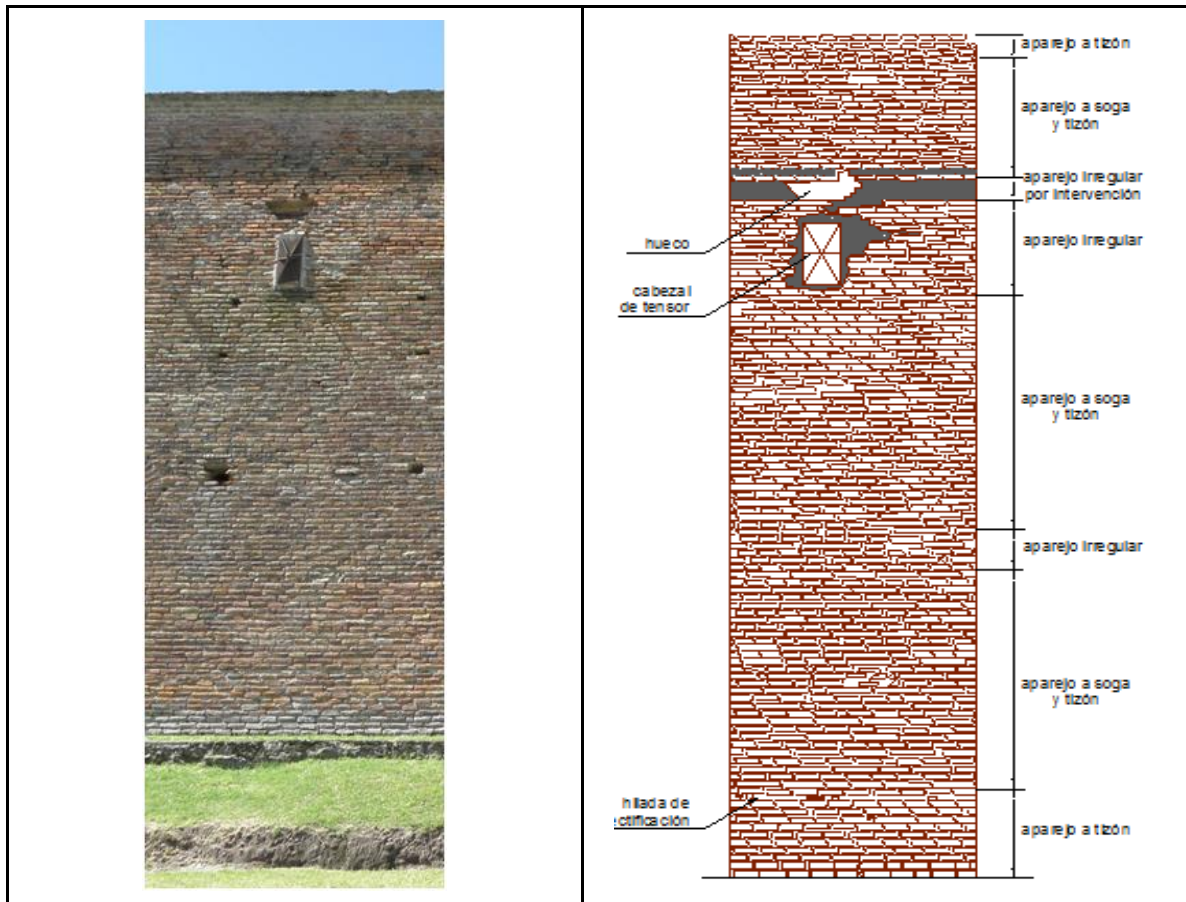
Detalle del aparejo de un sector de la fachada sur de la Capilla.
